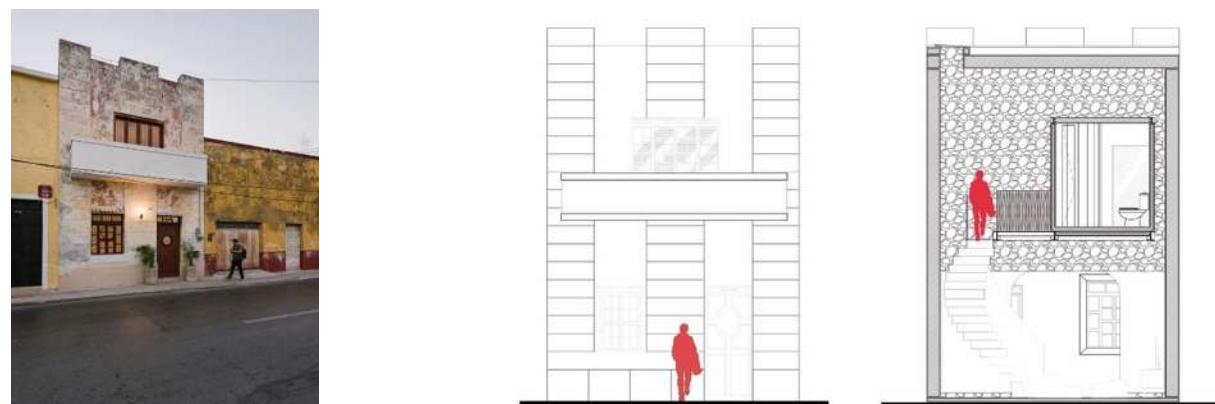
Y 17: Perspectiva de la casa y Alzado 2d del inmueble con alzado, [2019-noviembre-03].
